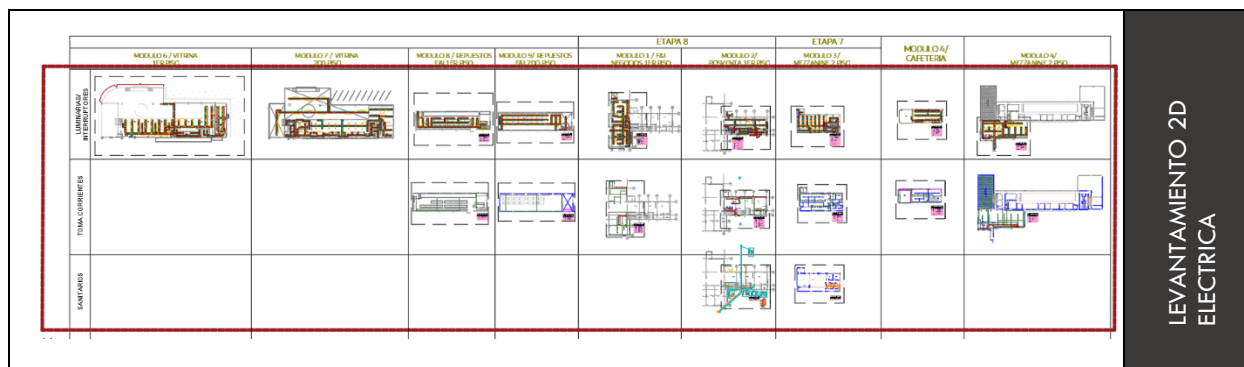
Levantamiento eléctrico 2D (16 planos) planimetría final
